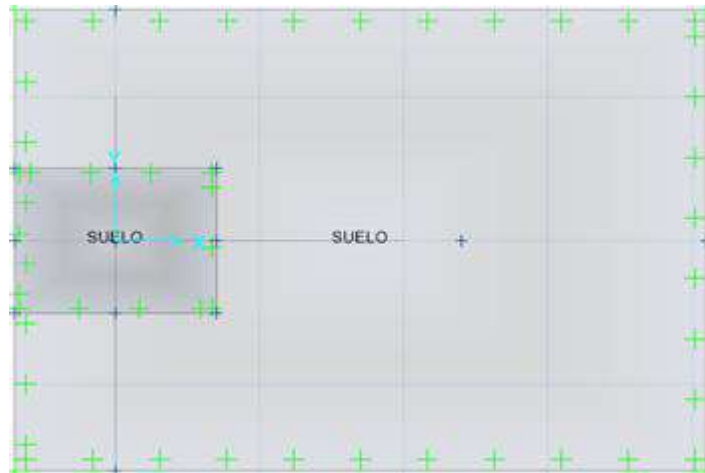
Asignando el suelo en la zapata Z1 y columna existente
